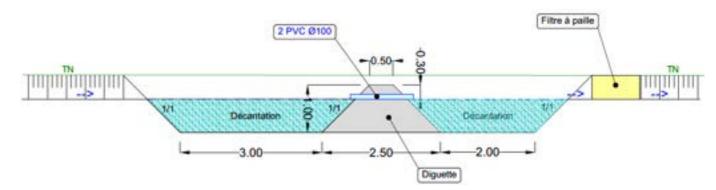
EXEMPLE DE COUPE TYPE DE BASSIN D'ASSAINISSEMENT PROVISOIRE AVEC FILTRE À PAILLE - (SOURCE : EGIS)
